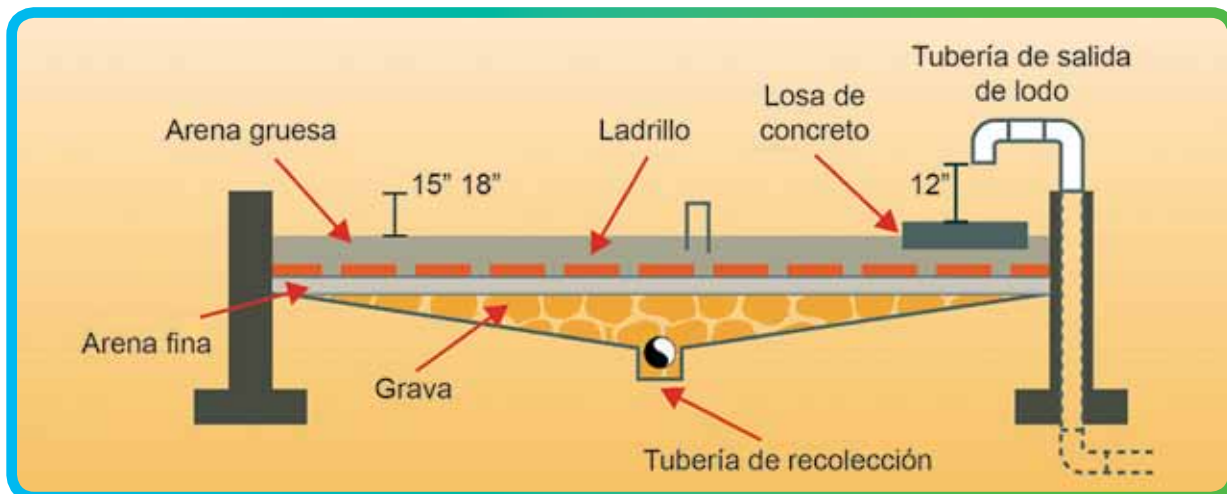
Corte transversal de una planta de lecho de secado.
